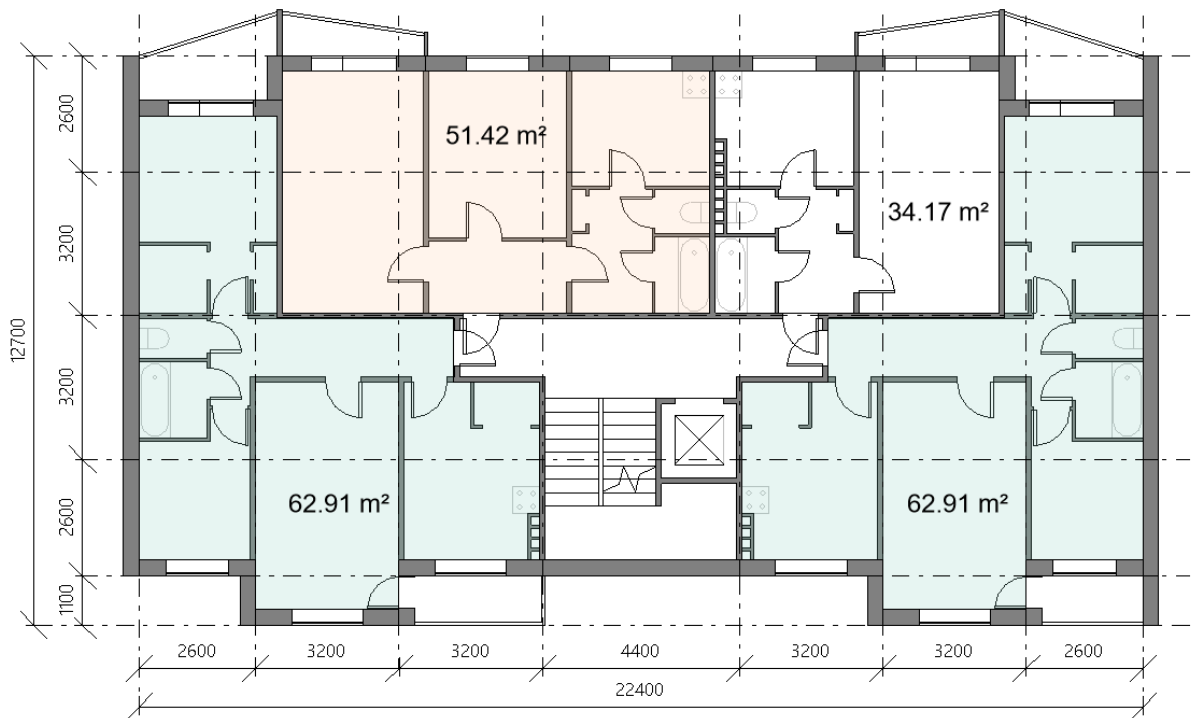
Планування рядової секції 1-2-3-3.
